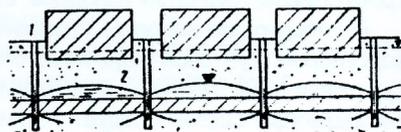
Головной дренаж (план и разрез): 1 - направление потока грунтовой воды;
